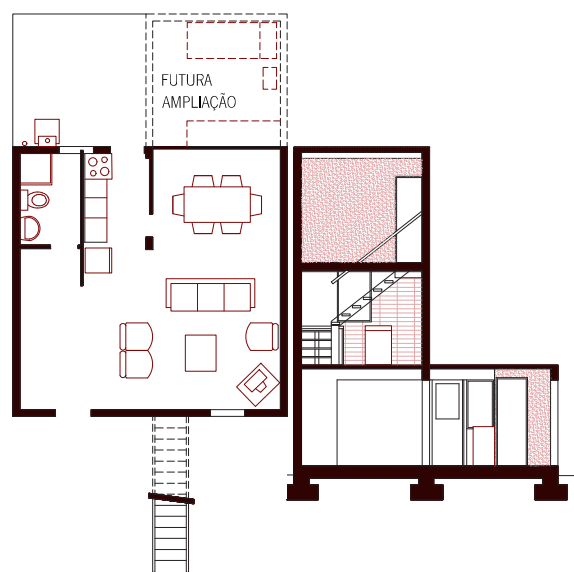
Plantas 1º piso e secção longitudinal - Quinta Monroy ELEMENTAL
